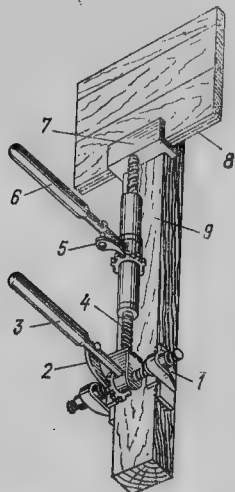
1 — захват винтовой; 2 — устройство храповое; 3 — рукоятка захвата; 4 — винты выдвигаемые; 5 — устройство сжима храповое; 6 — рукоятка; 7 — упор; 8 — доски; 9 — лаги
